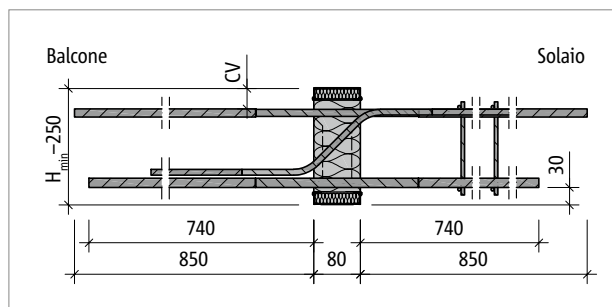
Schöck Isokorb® T tipo K-M13 - M14-V1/V2: sezione del prodotto
